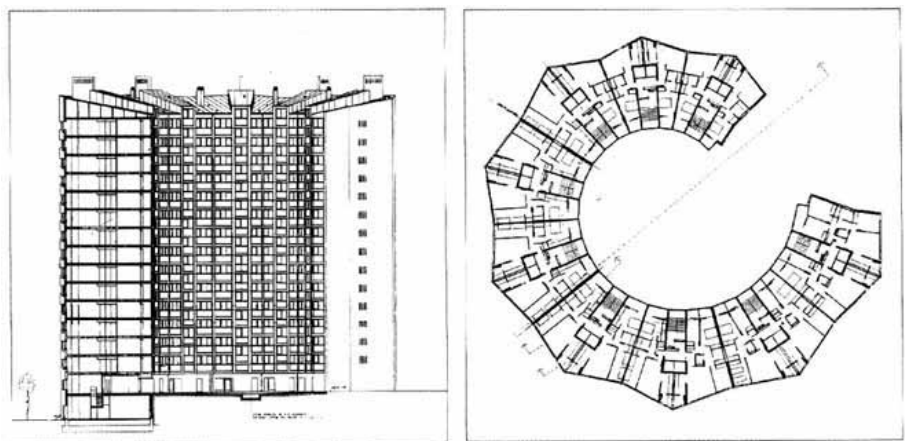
Planta y sección de la torre de 252 viviendas de Vallecas¹⁷⁰. Fuente: Lapeña y Elias Torres
